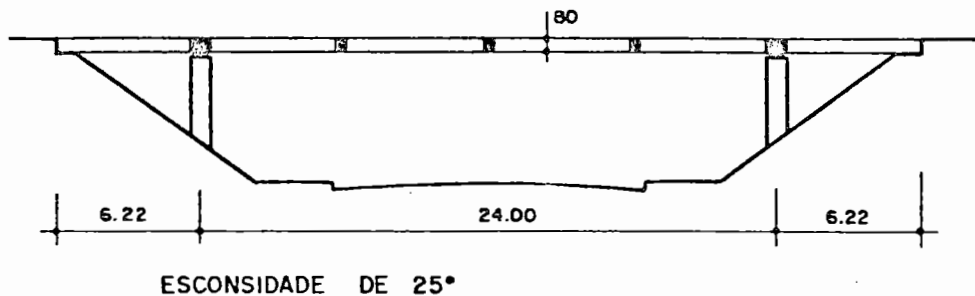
EXEMPLO DE PONTE EM VIGA COM SEÇÃO TRANSVERSAL EM LAJE VAZADA [MARTINELLI (1971)]
